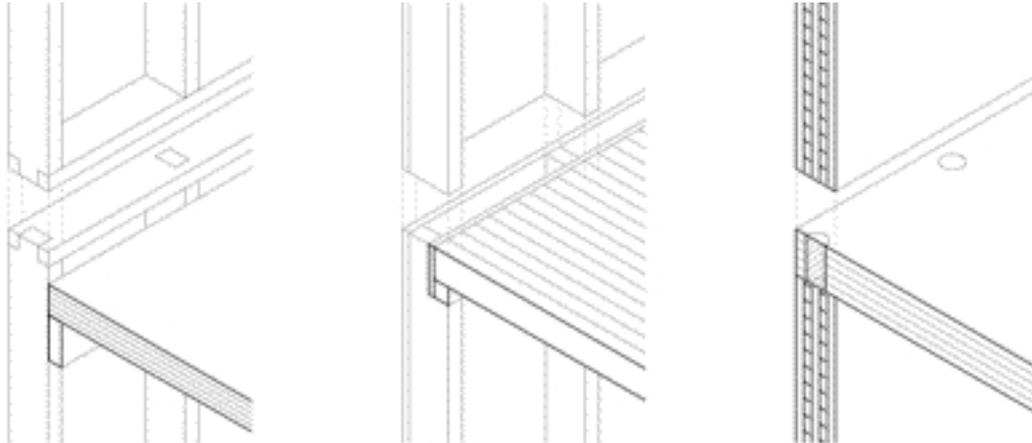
Deckenaufleger verschiedener Wand- und Deckenelemente, bei denen Querholzpressungen und damit Setzungen vermieden werden. Tafelbauelemente mit Hirnholzkontaktstoß der Ständer zwischen den Elementen sowie Brettsperrholzelemente, aus: Atlas mehrgeschossiger Holzbau, S. 44
